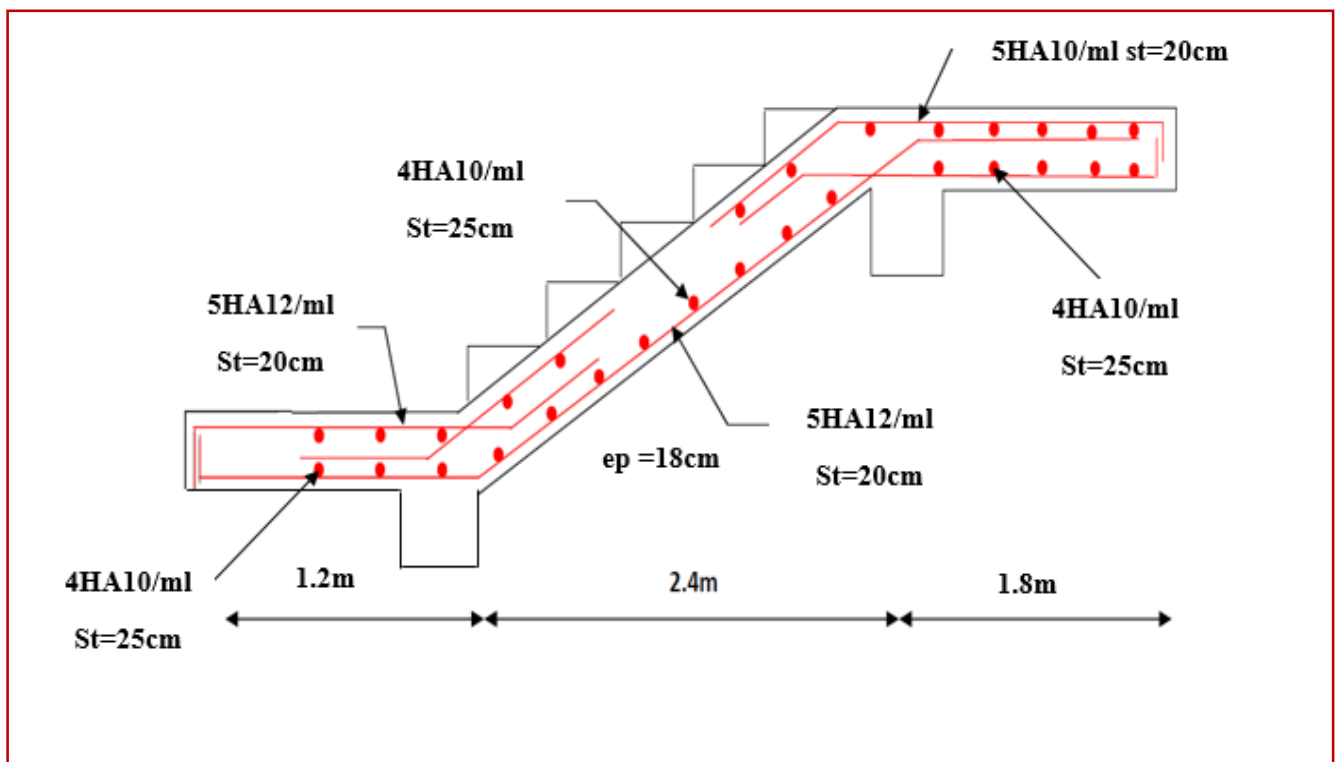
schéma de ferrailage de l'escalier RDC+EC
